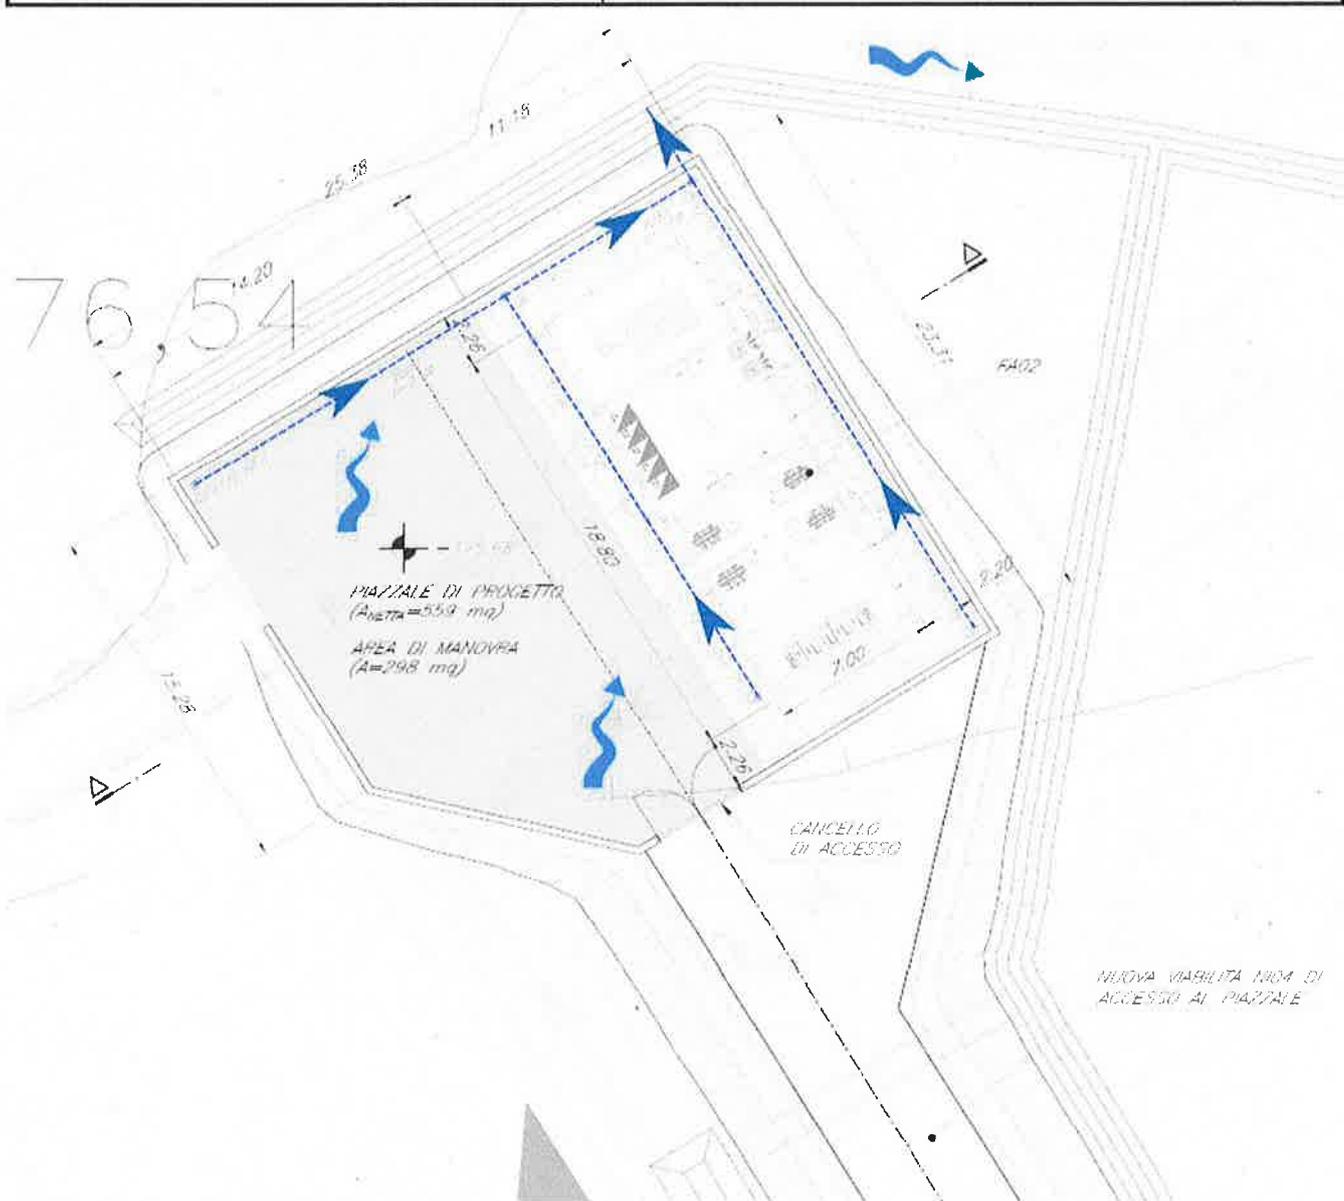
PLANIMETRIA PIAZZARE RI54
